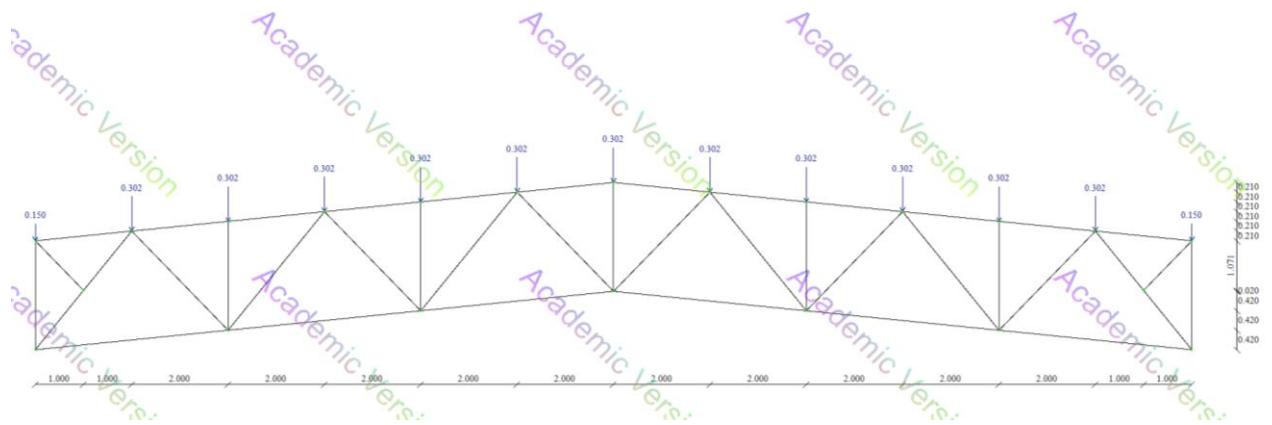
Розрахункова схема ферми за першим навантаженням (вага покриття)
